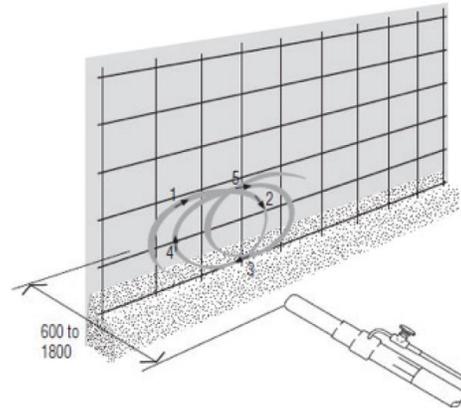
Esquemas de aplicación de hormigón proyectado de forma manual, aplicable al proyecto. Fuente: Guía Chilena del Hormigón Proyectado.
